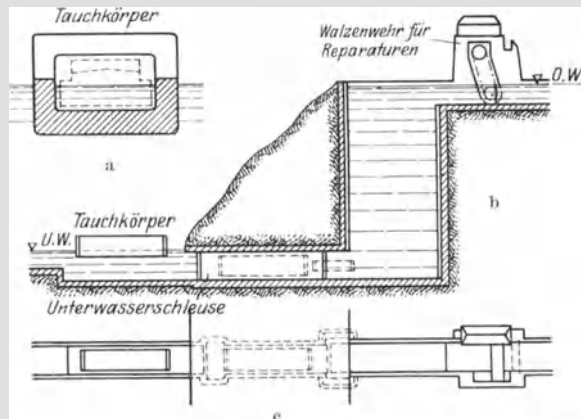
a bis c. Schiffshebewerk mit Tauchschacht.
